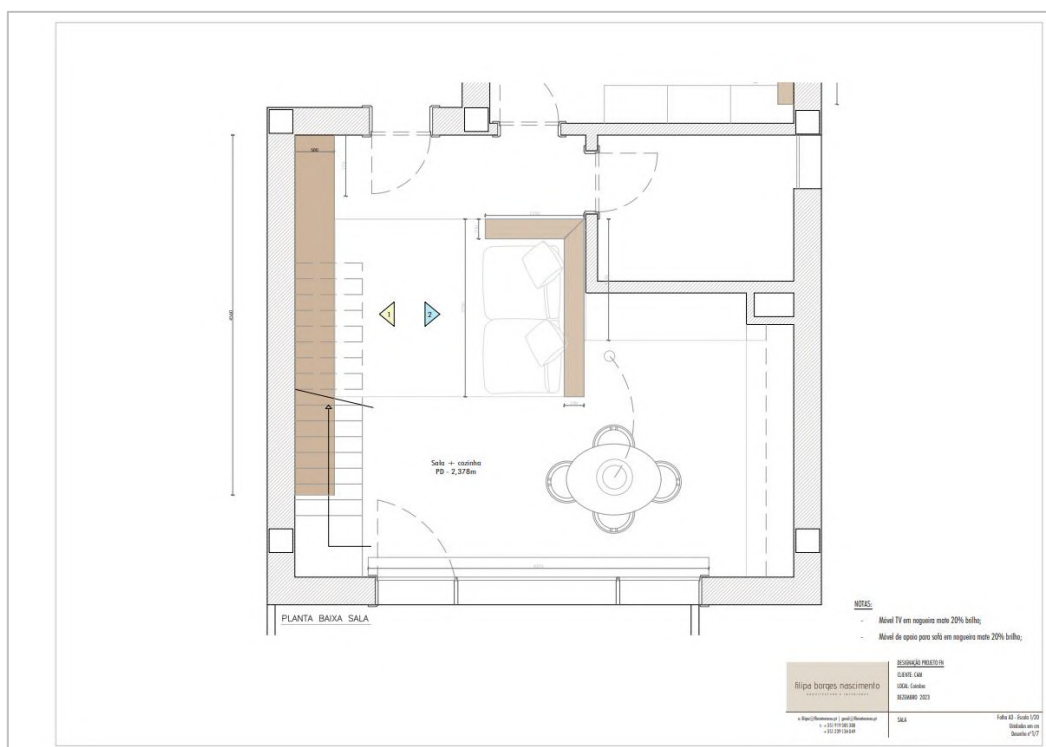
Planta de mobiliário - Projeto CM. Fonte: Autora.
